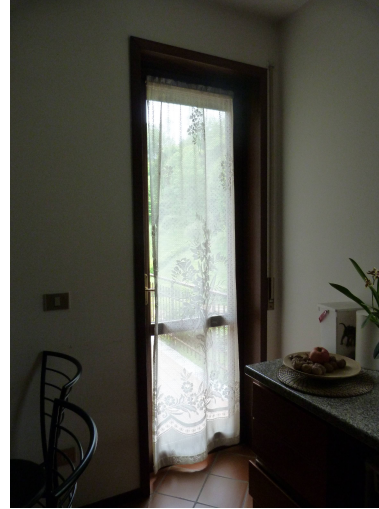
a 20 - Fotografie edificio esterno ed interni ,autorimessa e cantina.
